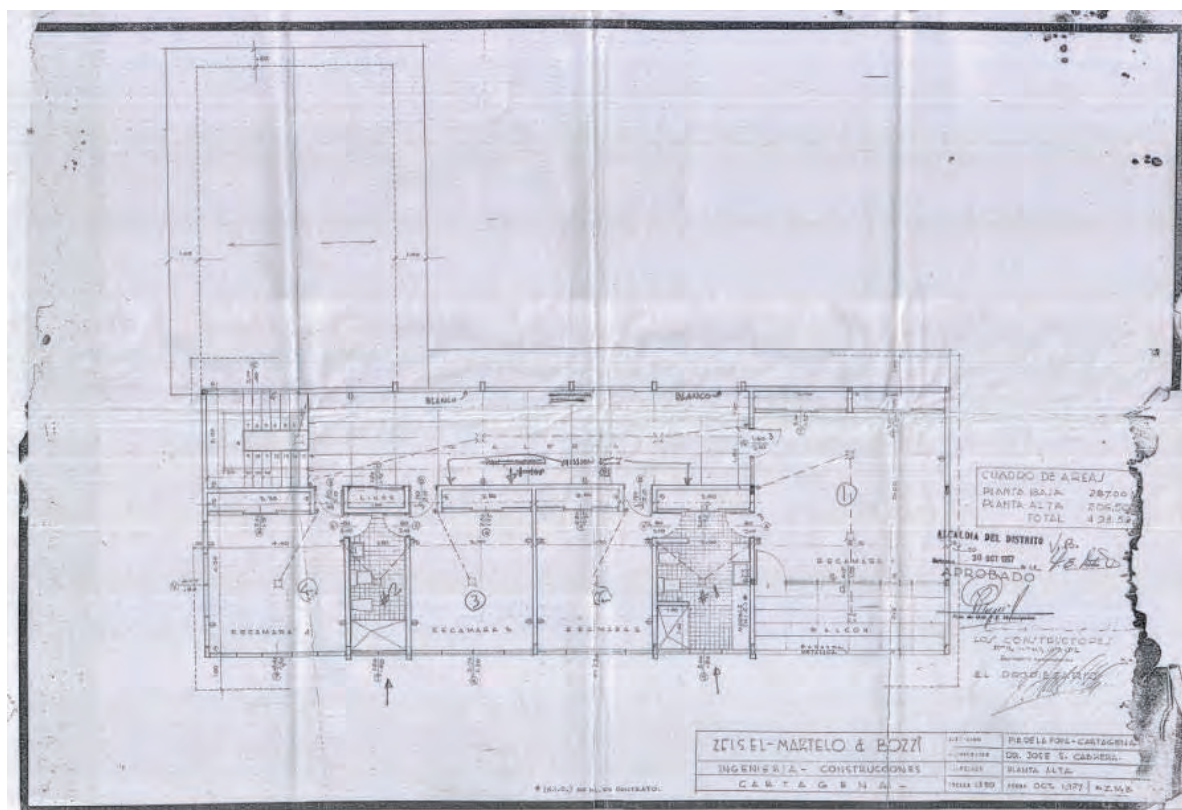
Plano de la segunda planta arquitectónica de la casa del Dr. José Cabrera. Distribución tipológica en “L”. Fuente: Archivo arquitecto Gregorio Cabrera, 1957.
